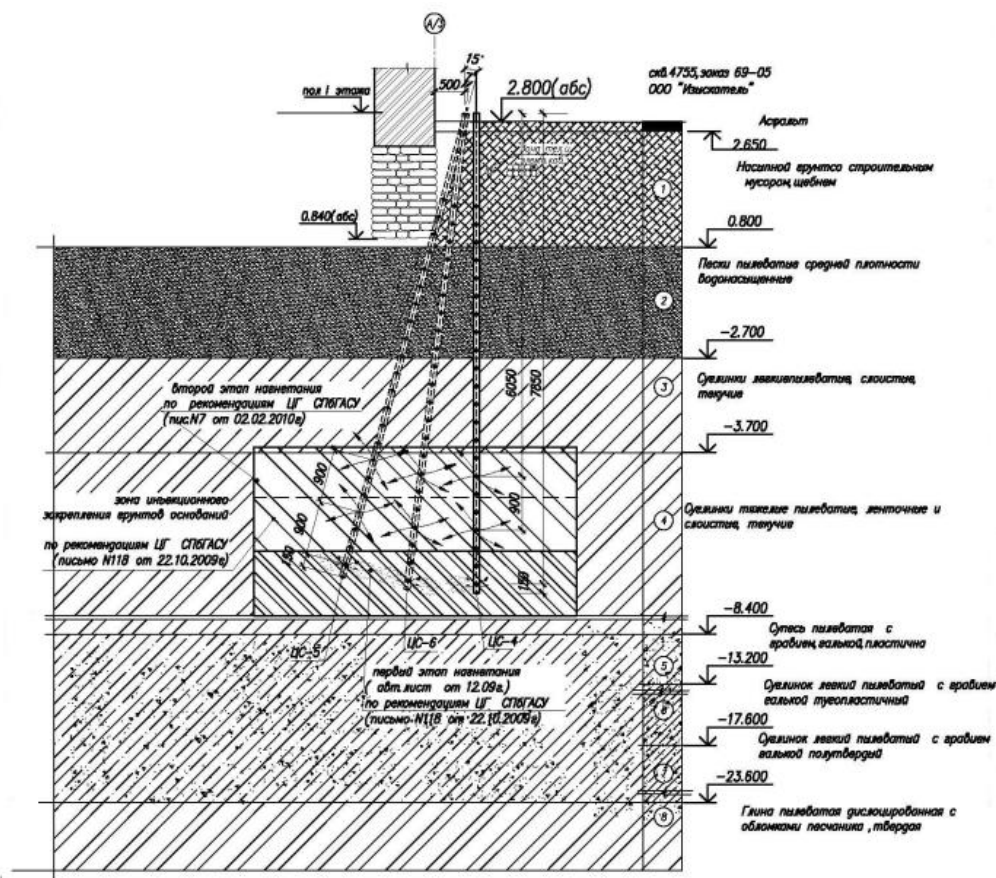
Проектное решение с устройством компенсационного нагнетания в грунтовой массив под подошву фундамента [147]
